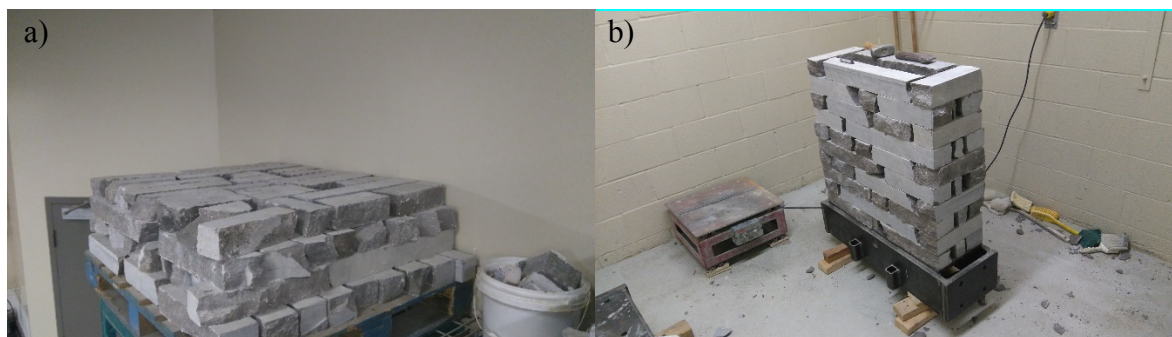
Assemblage d'un muret sans mortier : a) Pierre guillotinée avant taillage et b) Muret assemblé sans mortier
